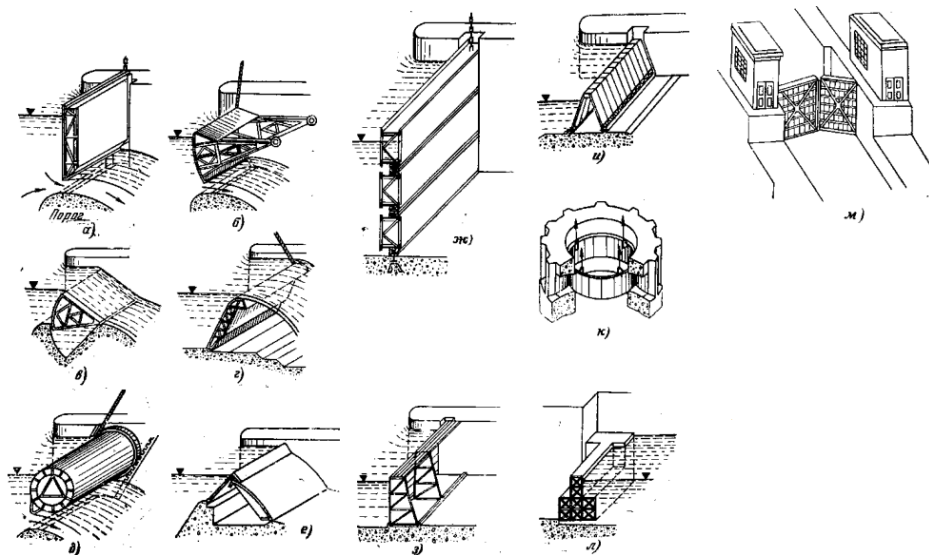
Типы затворов. а – плоский; б – сегментный; в – секторный; г – клапанный; д – вальцовый; е – крышевидный; ж – шандорный; з – с поворотными фермами; и – с поворотными рамами; к – вертикальный цилиндрический; л – плавучий; м – шлюзные двустворчатые ворота.
